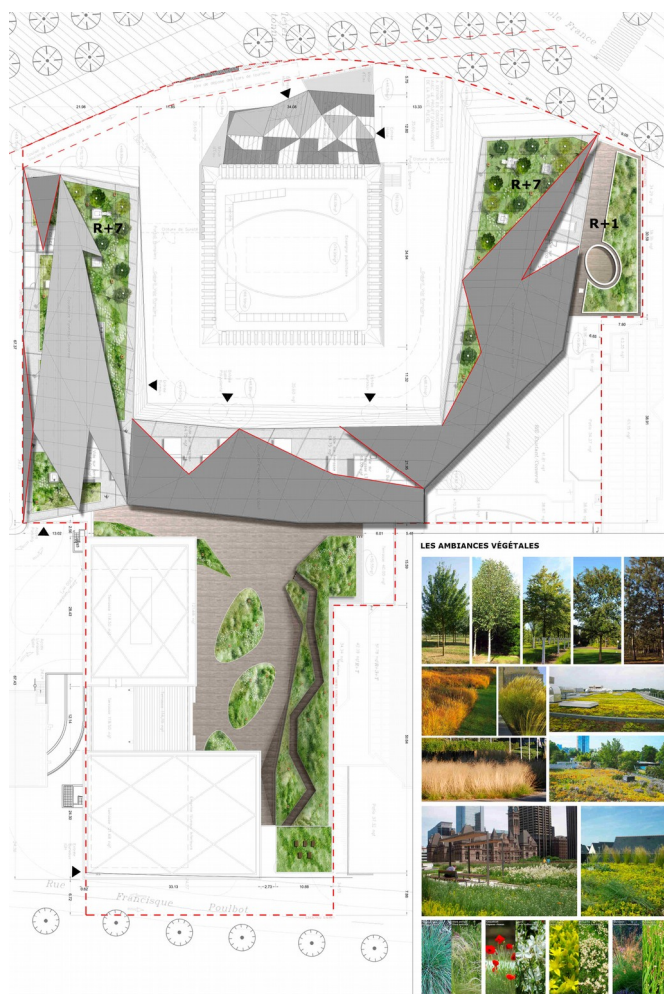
Vue en plan du projet (source : plan masse – volet paysage)
